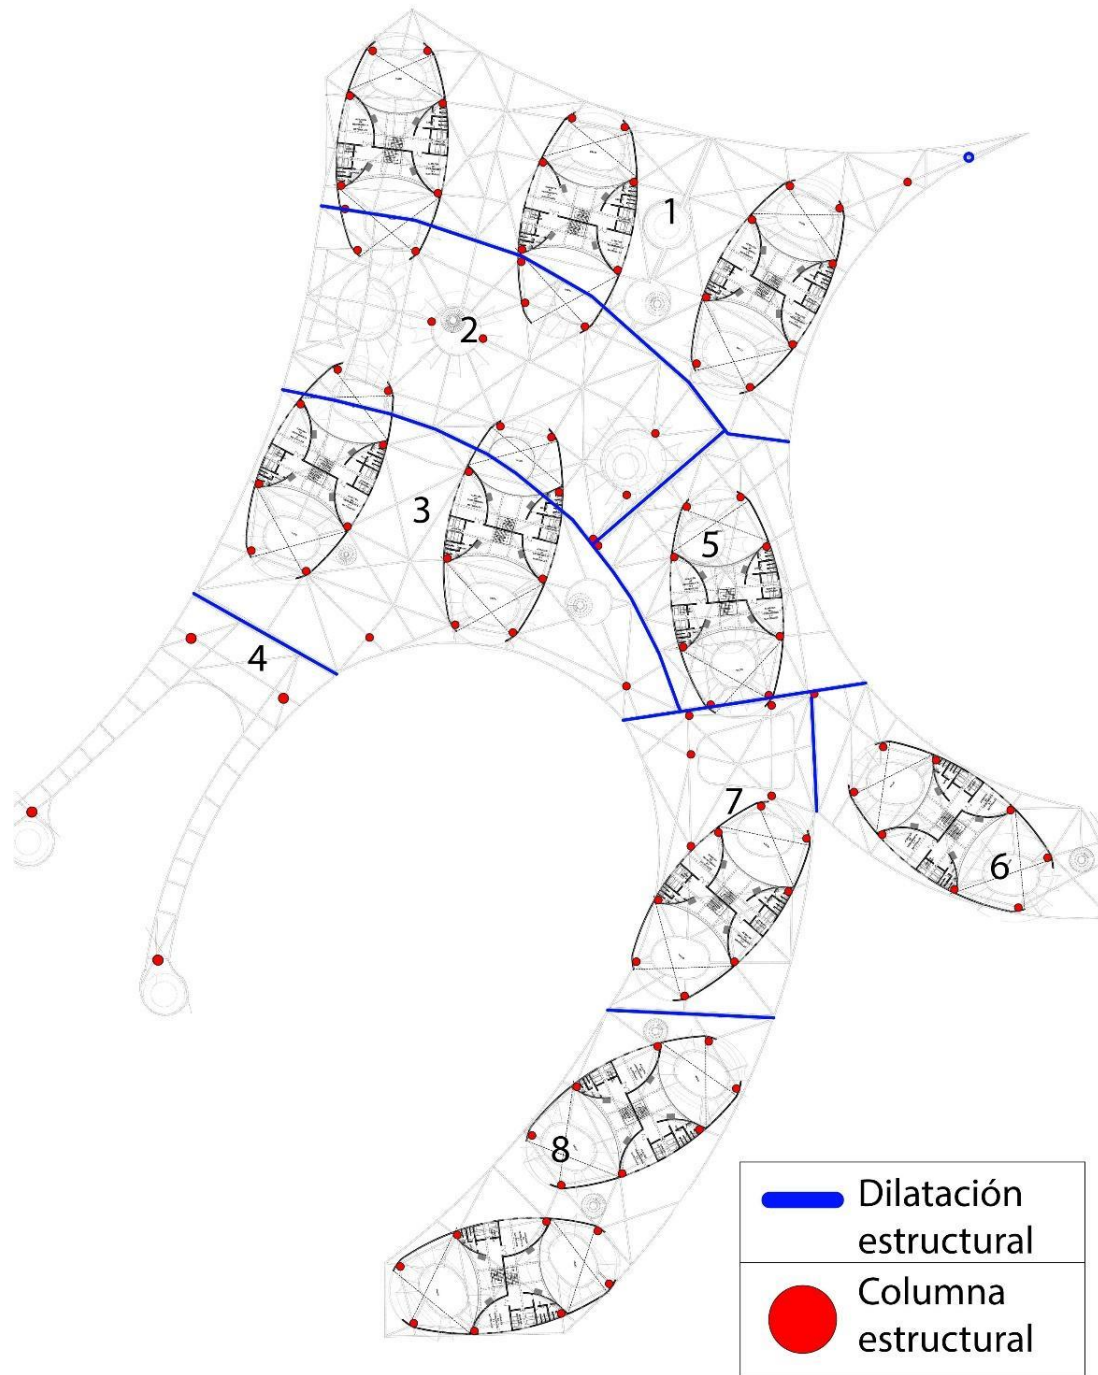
Plano de Núcleos Estructurales y Dilataciones.
